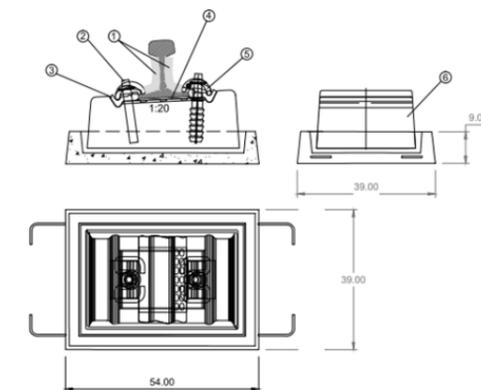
Tendido de vía en placa con bloques tipo Edilon o similar. Detalles
